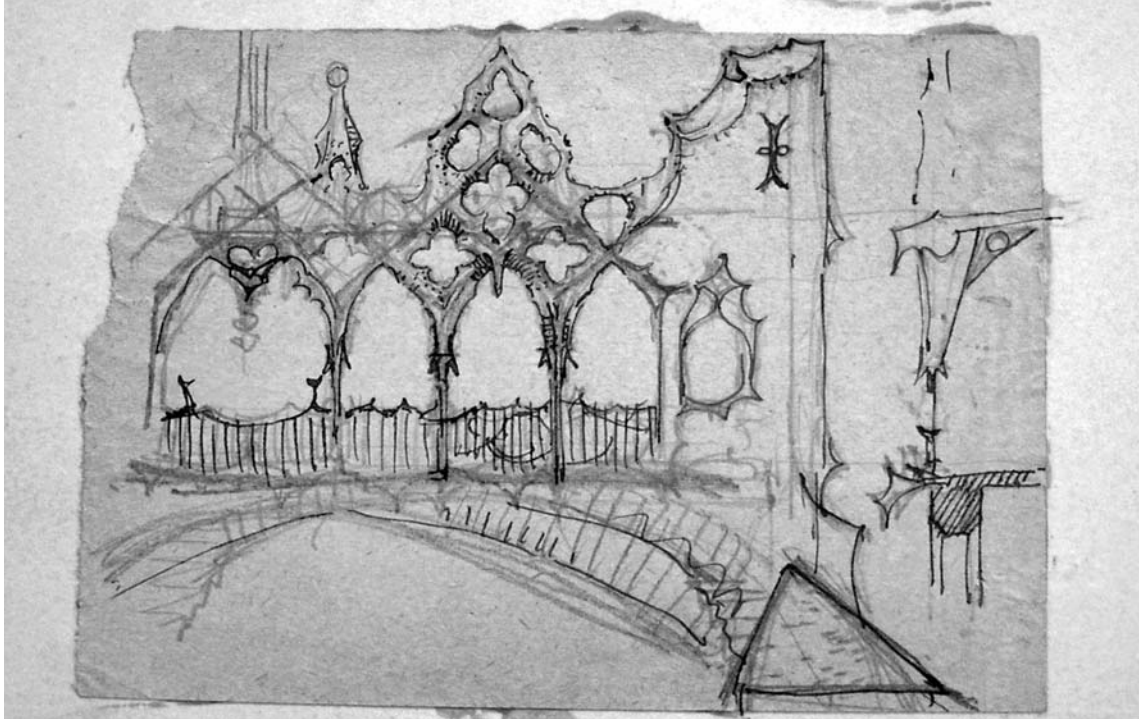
Croquis detall de la galeria de la façana posterior. Fons: Arxiu Jujol, s.d.
